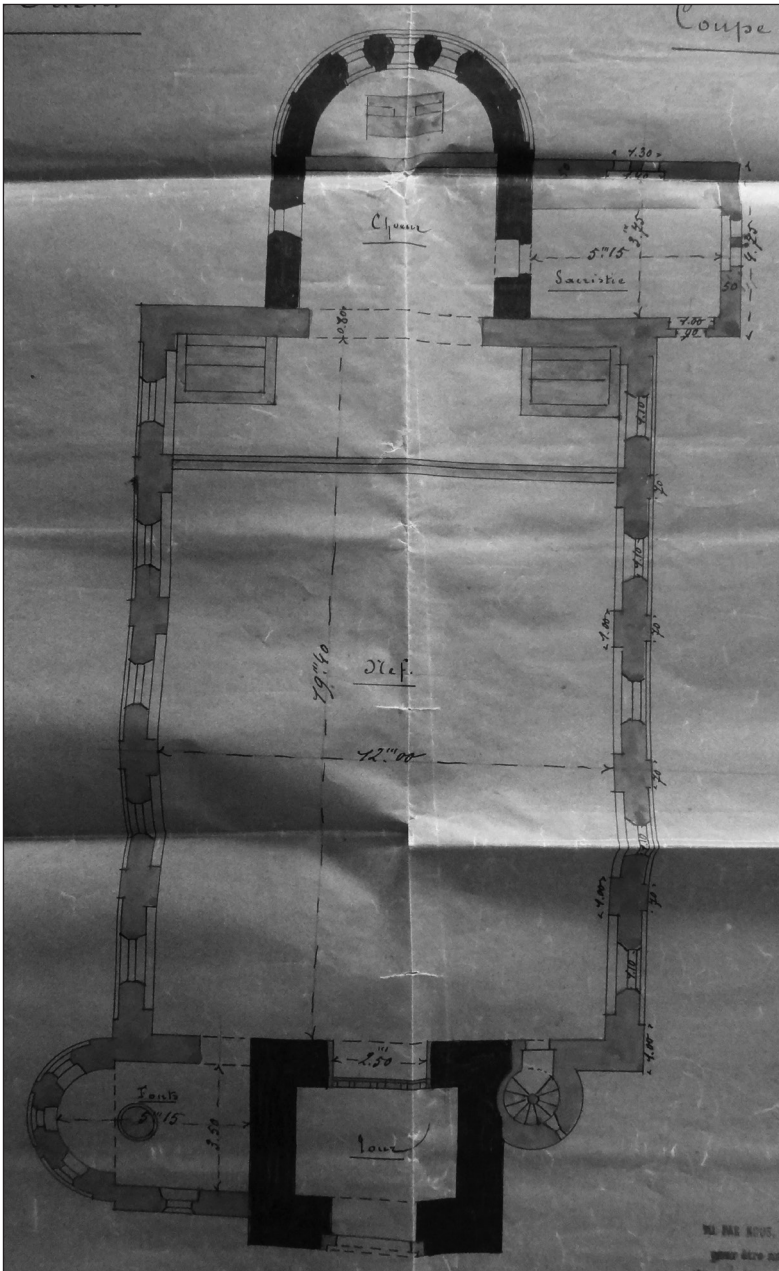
Premier projet d'Auguste Van Assche, plan.
